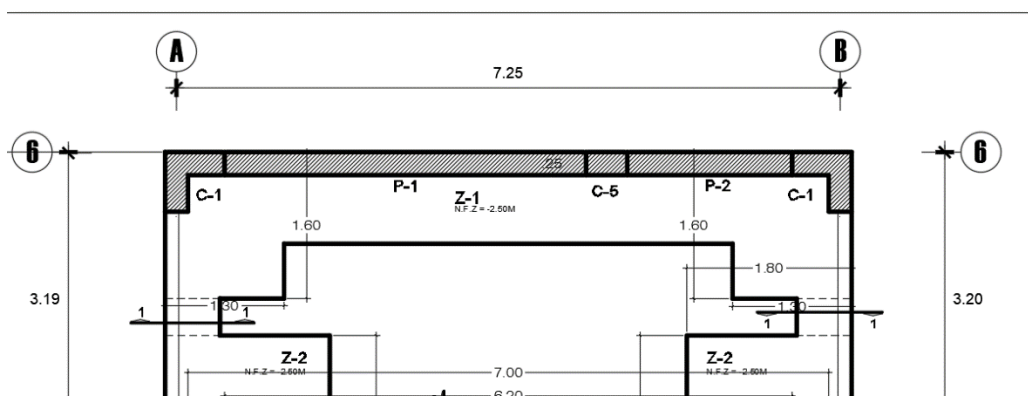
Plano CAD Estructuras – Planta Primer nivel Eje 6-6l
